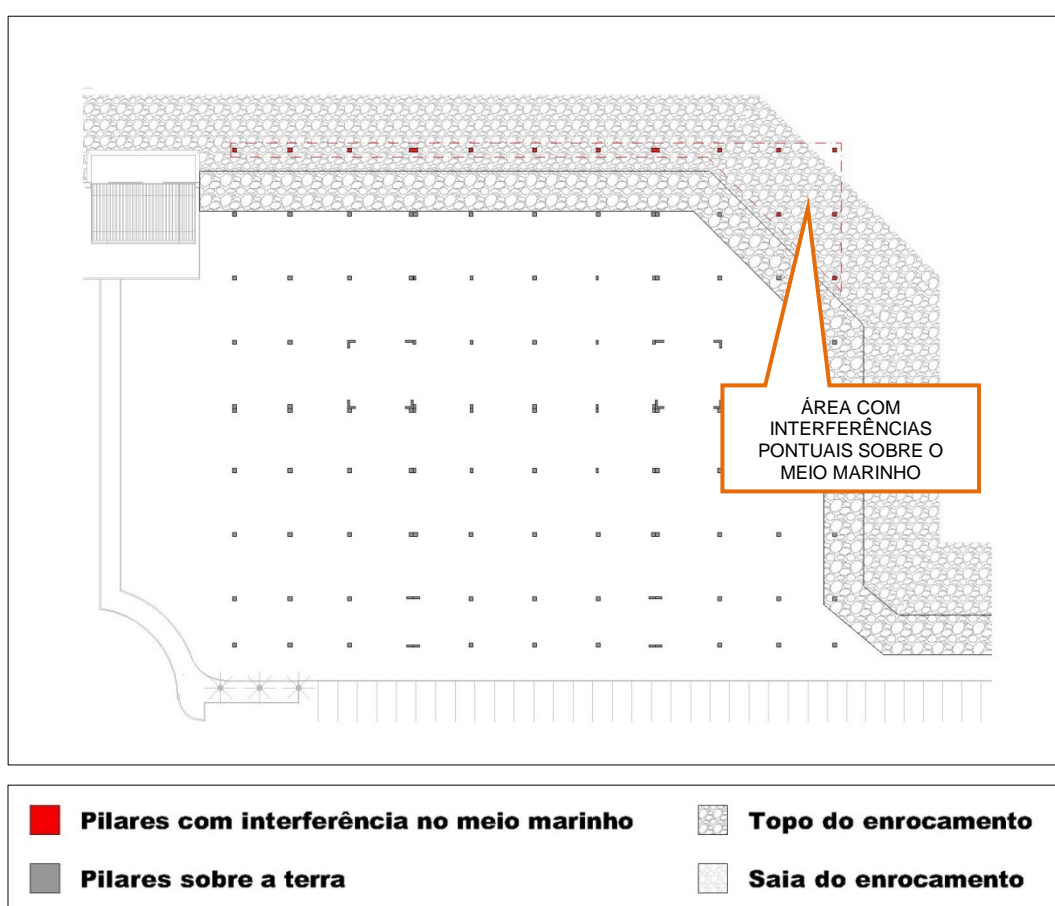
Indicação em planta da área de projeção da construção sobre a saia do enrocamento.
